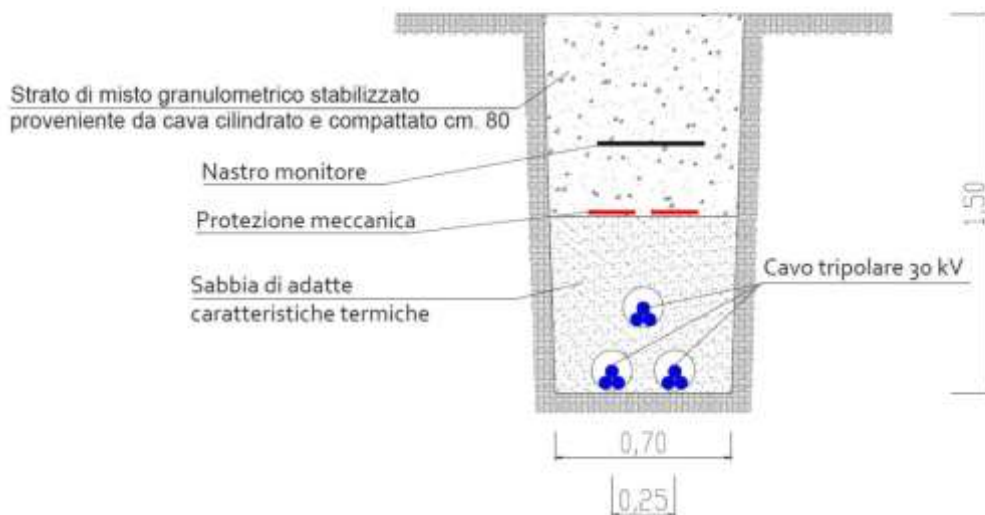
Sezione della trincea di scavo per la posa di n. 3 cavi da 30kV di collegamento dall'impianto FV alla Stazione di Elevazione – su strada sterrata
